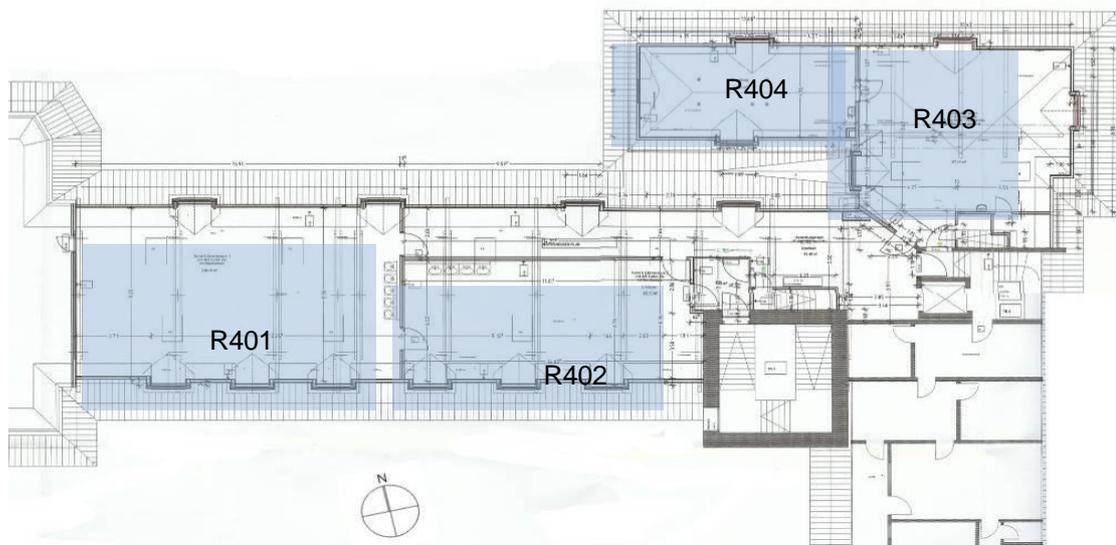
Grundriss des Dachgeschosses im alten Trakt des Schiller-Gymnasiums. Die blauen Flächen kennzeichnen vier Räume, die durch die raumluftechnische-Anlagen belüftet werden.
